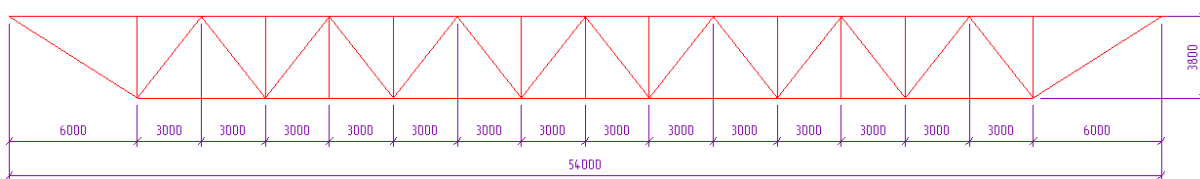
Расчетная схема стропильной фермы длиной 54 метров
